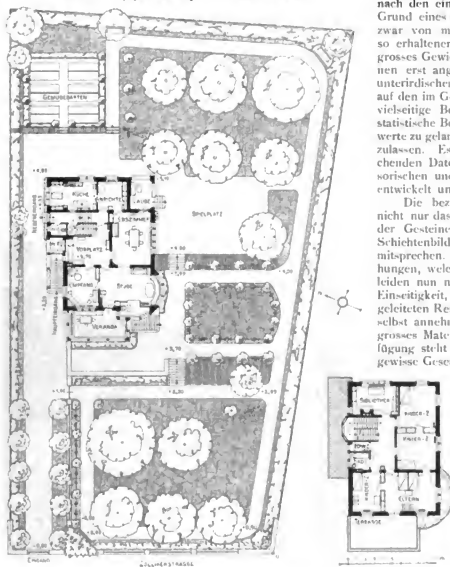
u. 3. Grundrisse vom Erdgeschoss und ersten Obergeschoss sowie Lageplan des Gartens.
